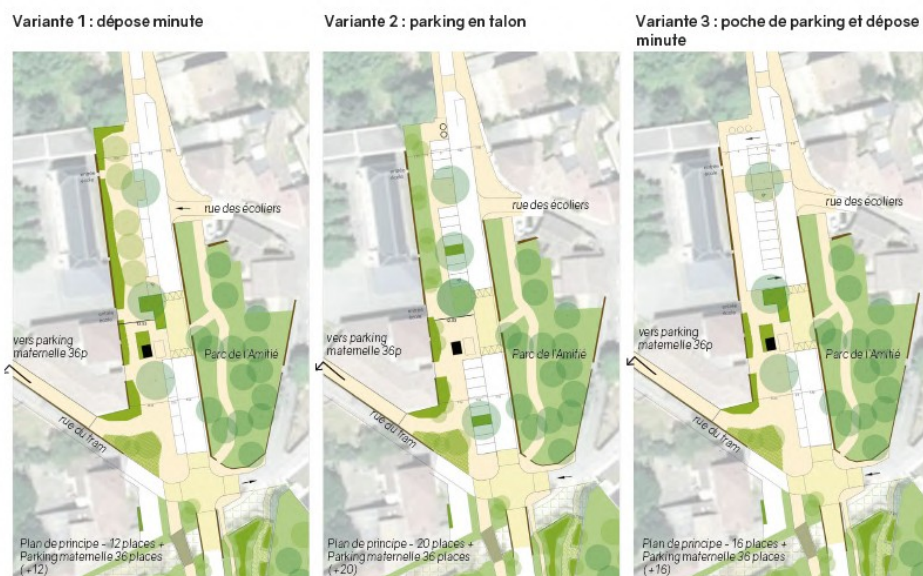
Exemple de variantes issues du plan guide pour une zone (source : Urban Studio)
